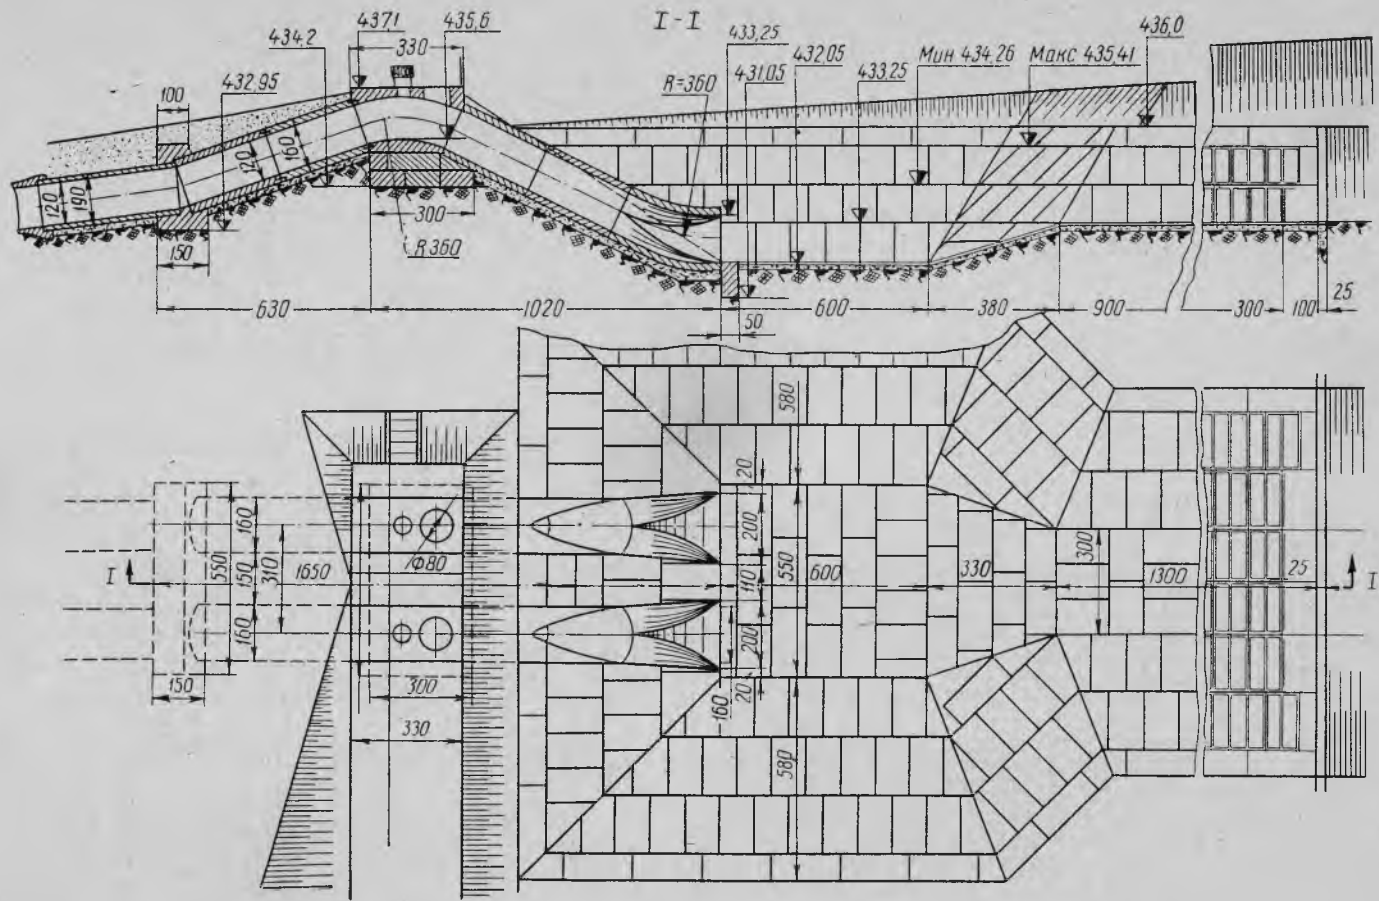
Прямоточный двухтрубный водовыпуск сифонного типа с откосными стенками бассейна; крепление сборными железобетонными плитами.
